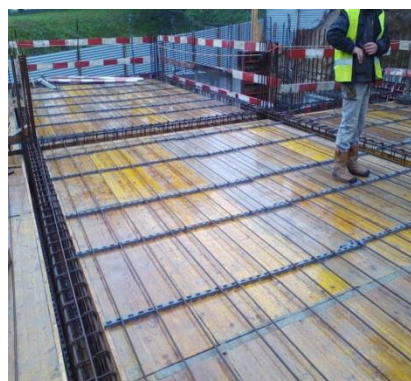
Início da armação da laje do piso 1, EMPREENDIMENTO 2
